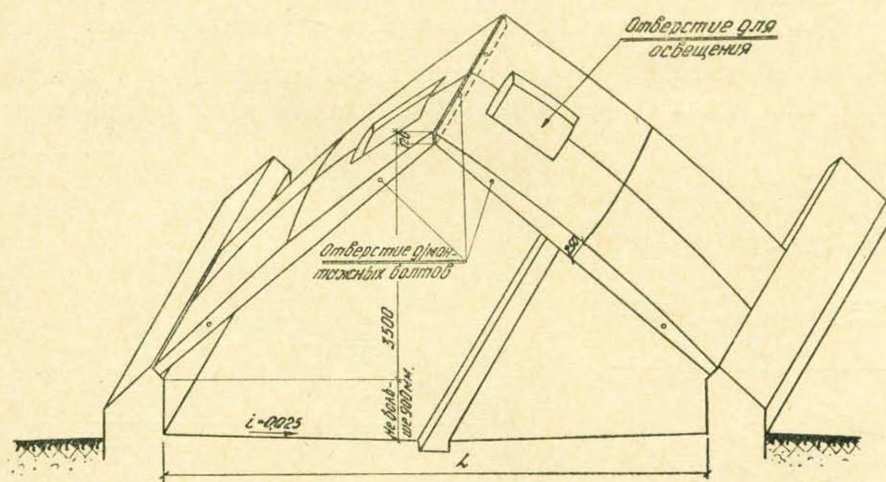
Сборное железобетонное покрытие в виде оболочки с отверстиями для освещения.
